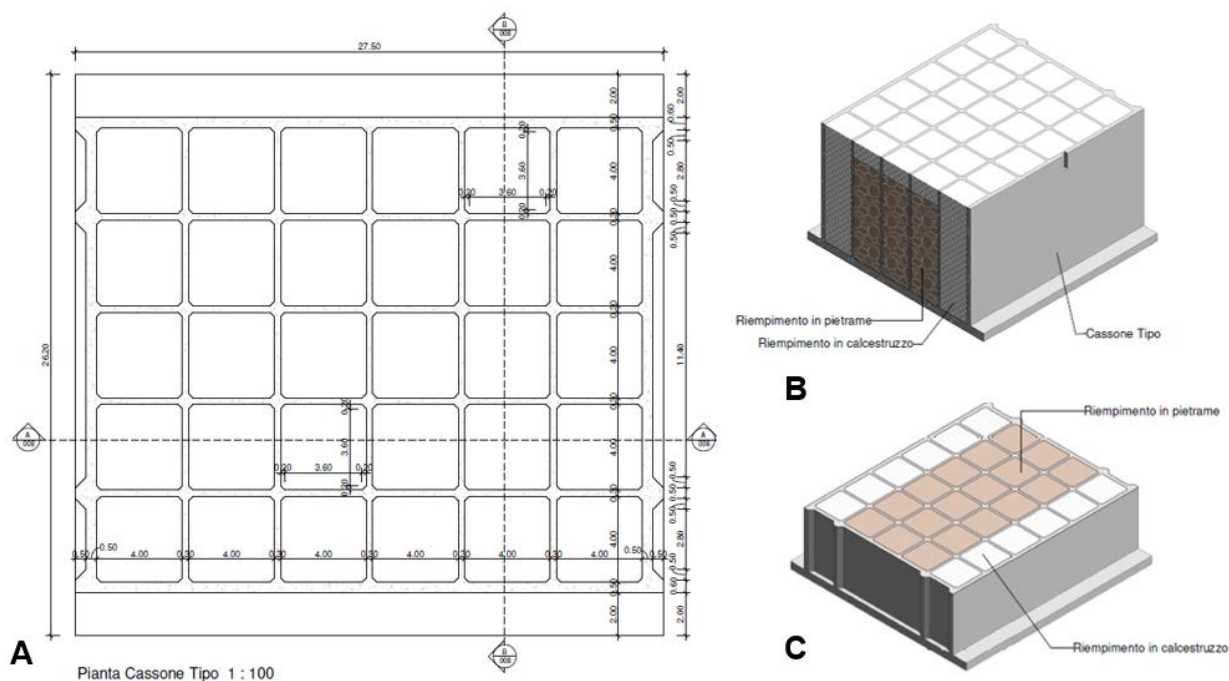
2 Pianta cassone – tipo (A) e viste 3D con riempimento in pietrame (B) ed in cls (C).
